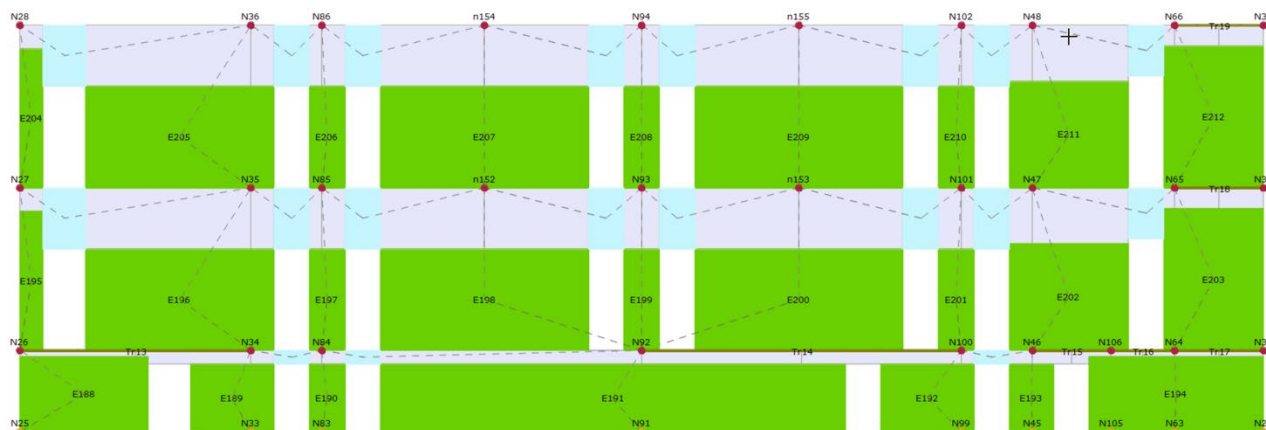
Sollecitazioni Parete P6 | Muro di spina longitudinale
